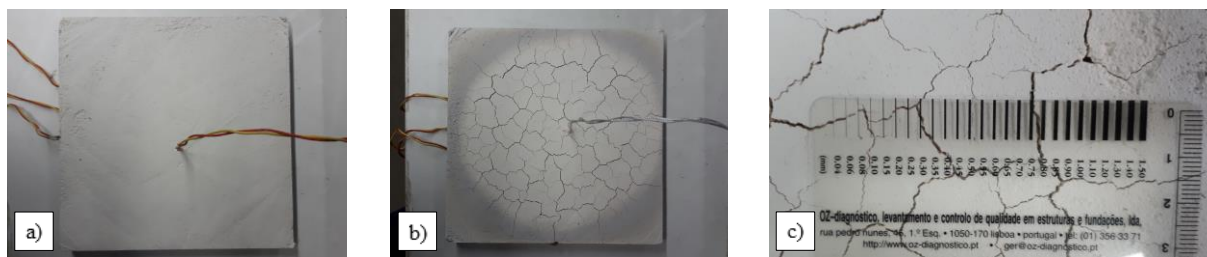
Provete P_A2_1_LA: a) Provete antes do ensaio; b) Provete após o ensaio; c) Fissuração do provete após o ensaio.
